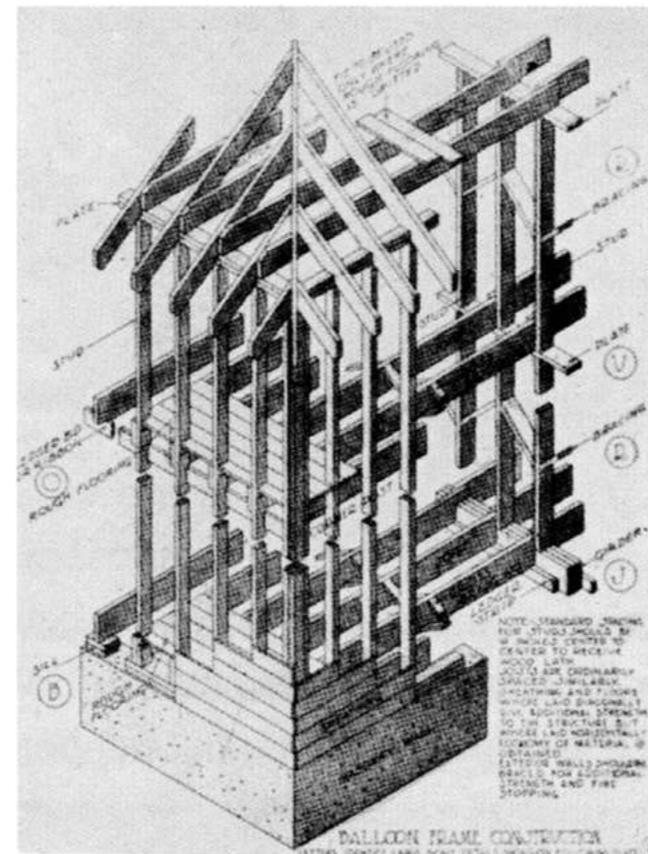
, Zeichnung der Balloon Frame und Western Frame Konstruktion
